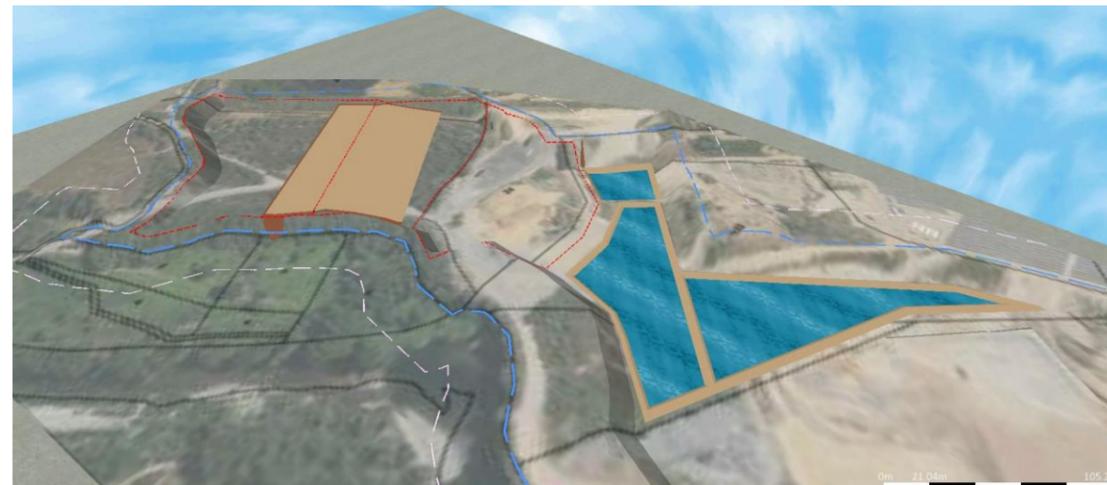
Aménagement de l'extension de carrière plan de masse et plan 3D (0 + 15ans) (Source : Arca2e)
